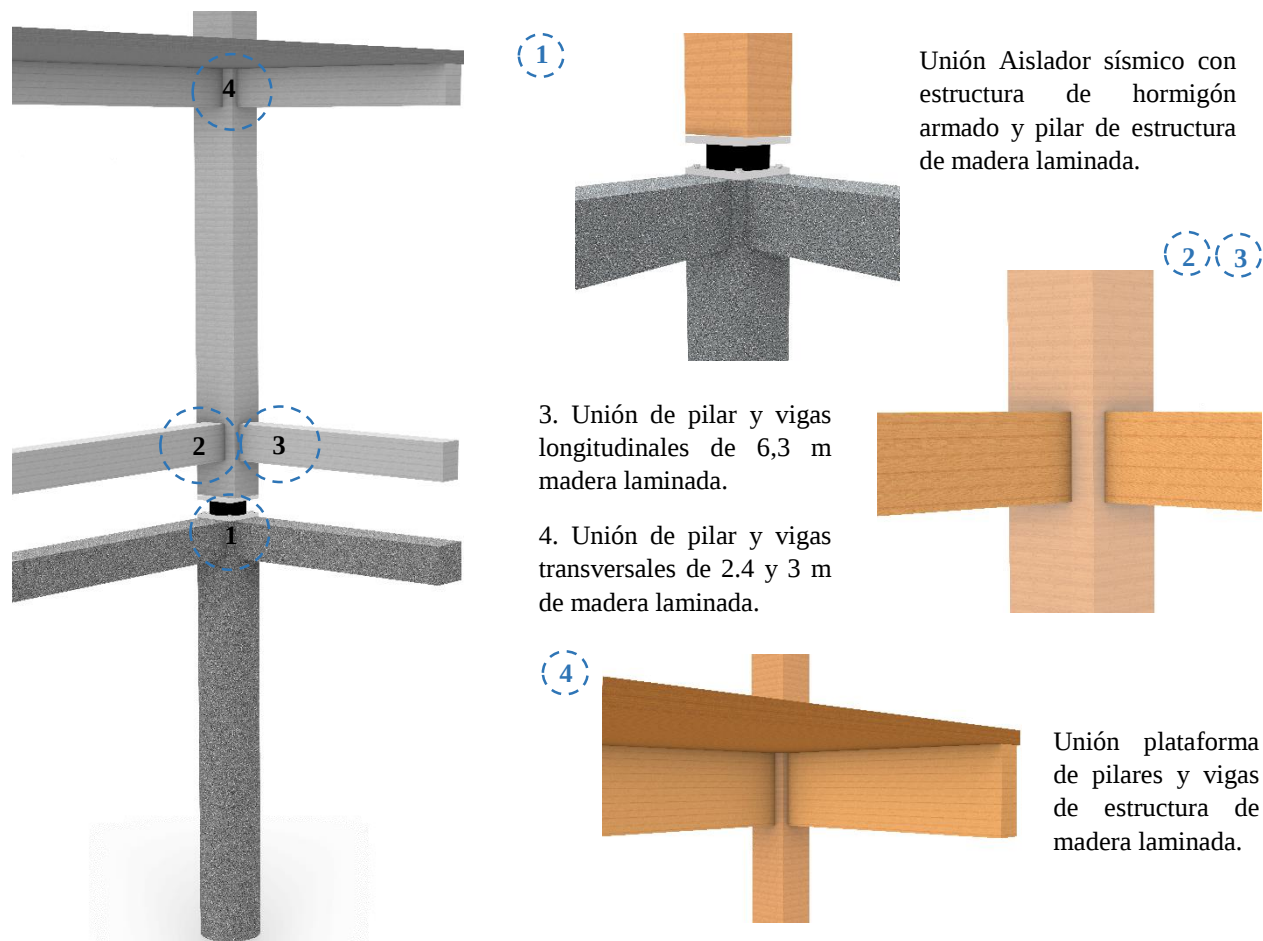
Modelo puntos de conexión de sistema constructivo. Elaboración Propia
